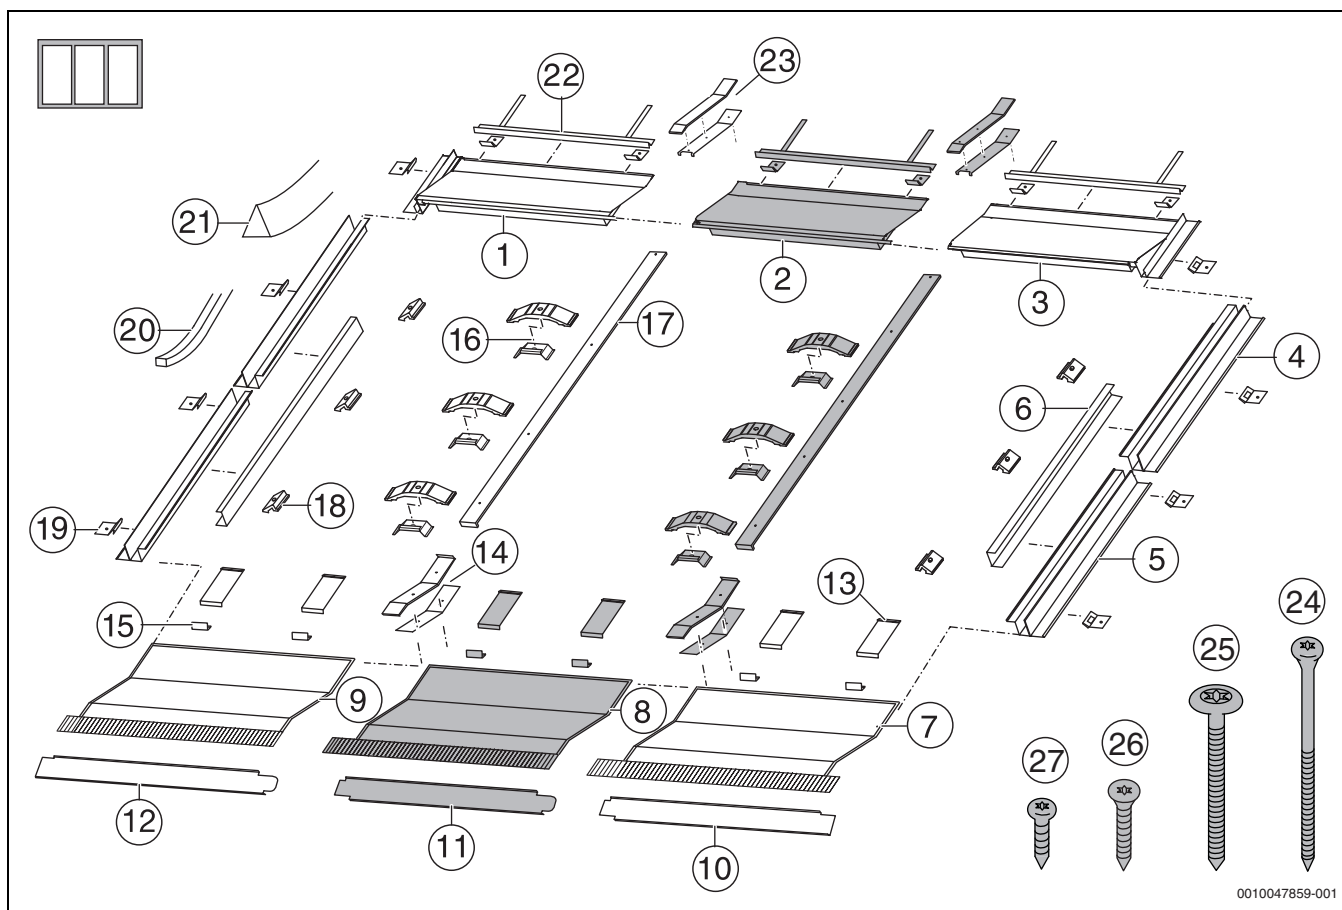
Set di fissaggio/montaggio per 3 collettori verticali: 1 × versione di base per i primi due collettori e 1 × set di fissaggio/montaggio (grigio) per ogni collettore aggiuntivo
